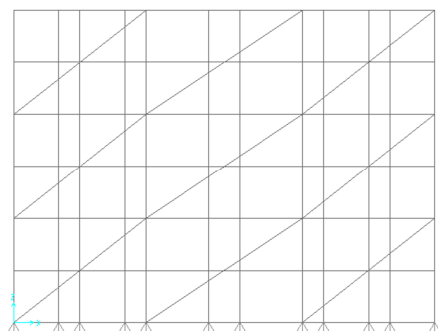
Configuração dos Planos de Contraventamento Vertical Com Elementos de Contraventamento Grandes
